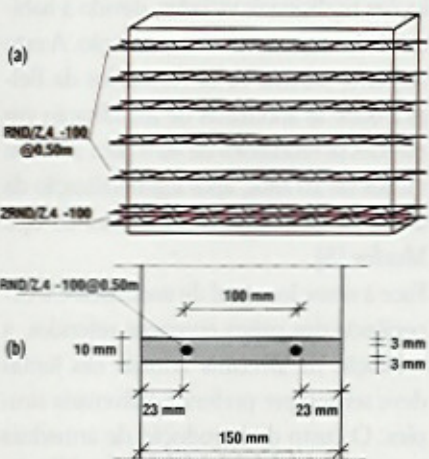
Armadura para controlo de fendilhação numa parede com a espessura de 0.15 m: (a) alçado da parede; (b) pormenor da junta, em secção transversal
